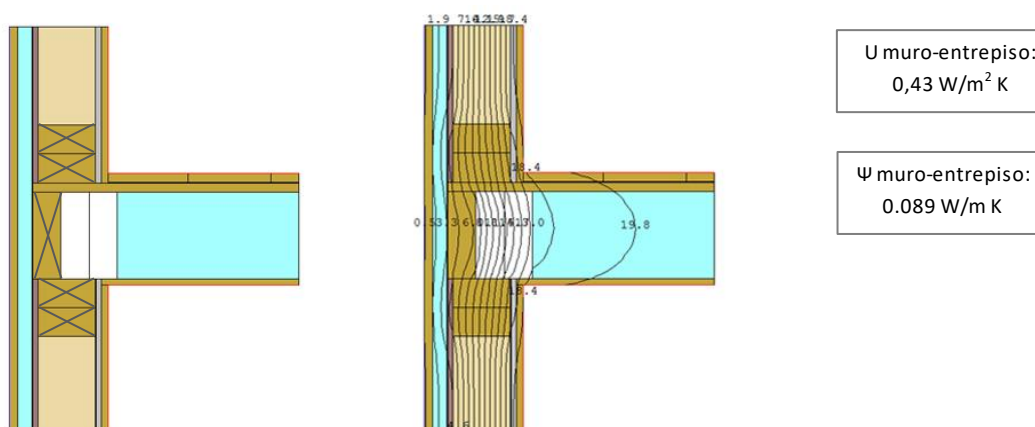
Detalle y diagrama isotermas unión muro - entrepiso, tabiquería 2"x4" en vista de corte
